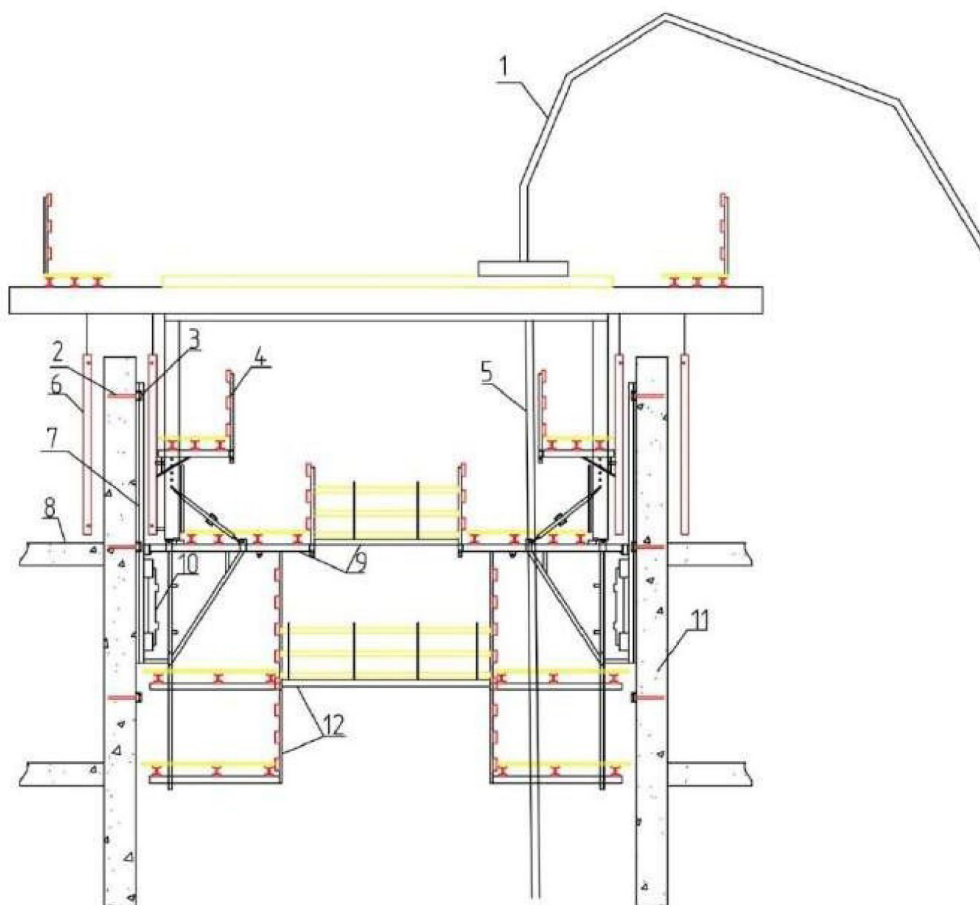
Система самоподъемной опалубки с распределительной стрелой при возведении монолитного здания: 1 – распределительная стрела; 2 – крепежный анкер; 3 – навесной башмак с гравитационным механизмом; 4 – подмости для выполнения бетонных работ и вибрирования; 5 – бетоновод; 6 – щит опалубки; 7 – направляющая балка; 8 – железобетонное монолитное перекрытие; 9 – подмости рабочие; 10 – гидравлический домкрат; 11 – железобетонная монолитная стена; 12 – подмости нижние
